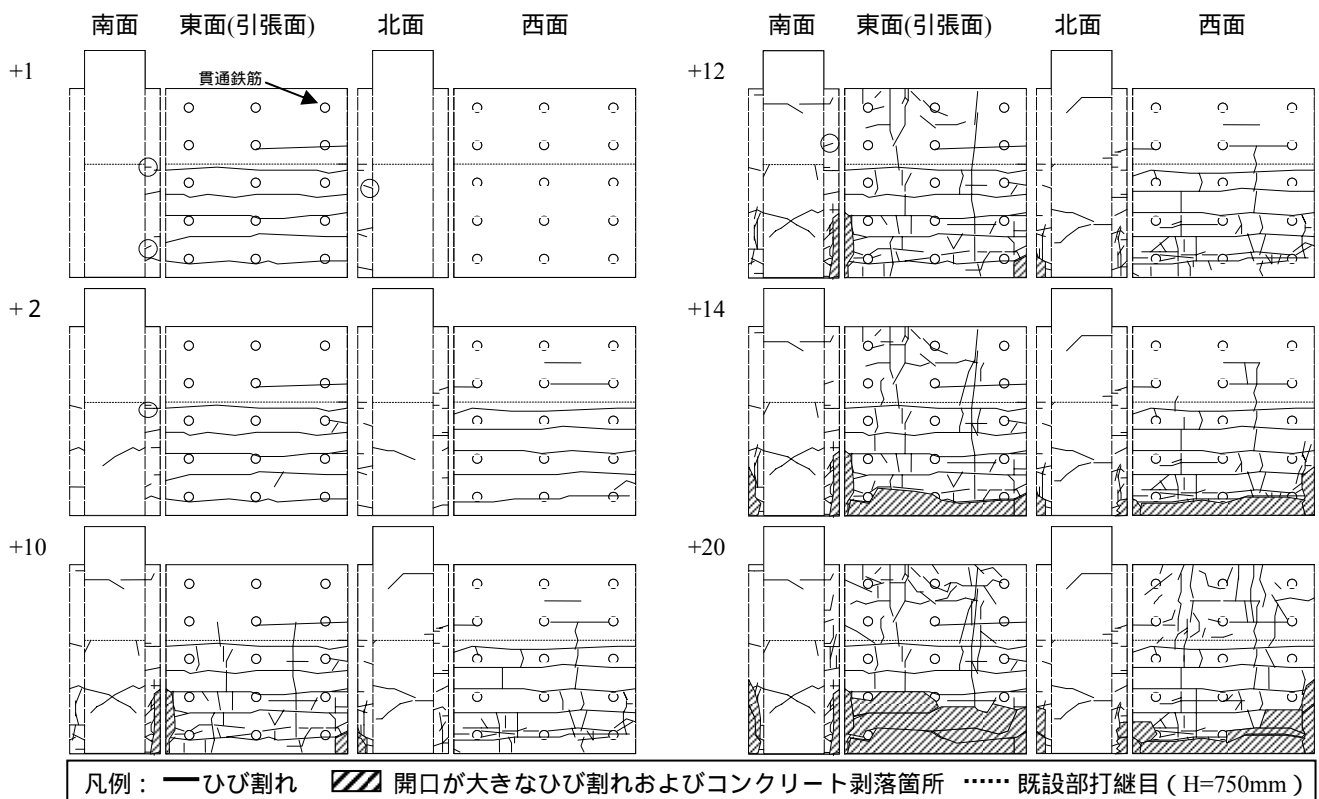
試験体表面ひび割れ発生図 (RC-S-16)
